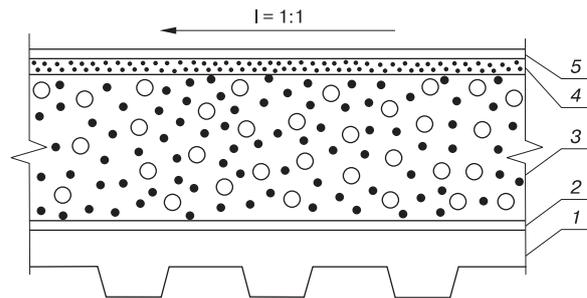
Конструкция покрытия: 1 – профилированный настил; 2 – пароизоляция из слоя армогидробутила; 3 – утеплитель из вермикулитопенобетона; 4 – стяжка из цементно-песчаного раствора; 5 – гидроизоляционный ковер из двух слоев армогидробутила
